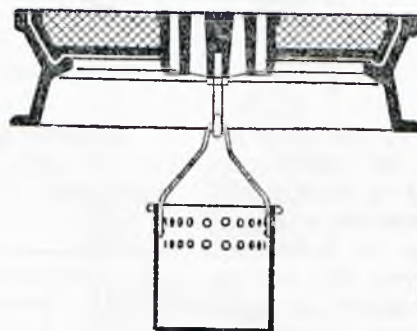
Skrzynka włazowa przejazdowa okrągła typu ciężkiego, wypełniona asfaltem
